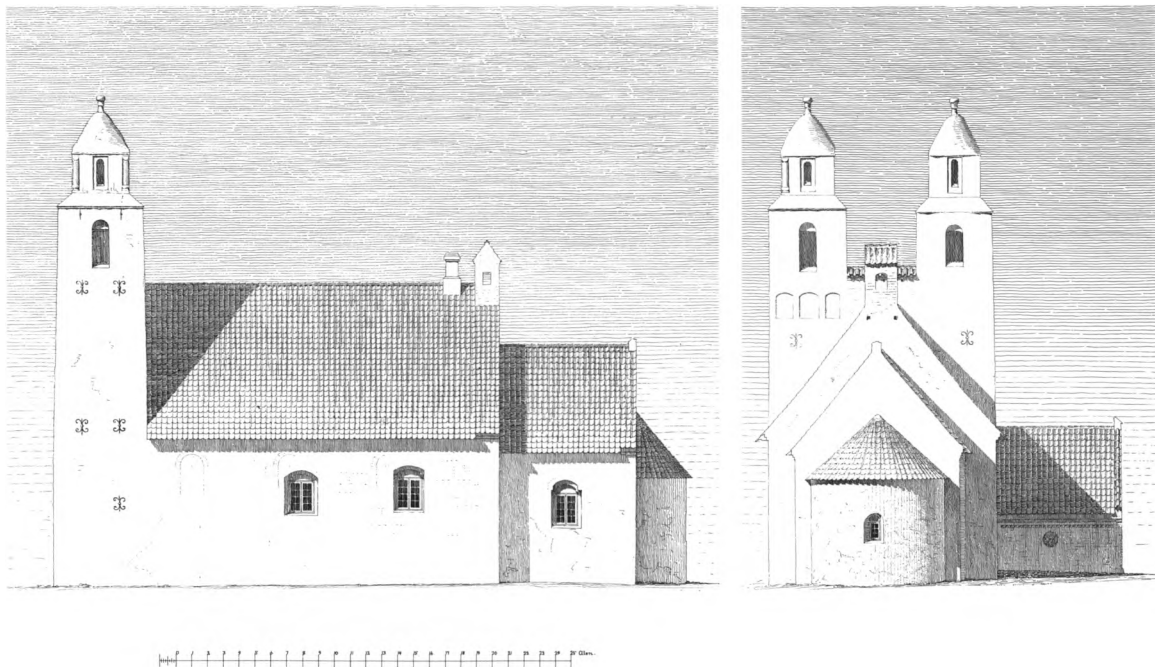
b. Opstalter. 1:300. a. Sydfacade. b. Østfacade. Målt og tegnet af H. B. Storck 1888. - Elevations. a. South facade. b. East facade.
